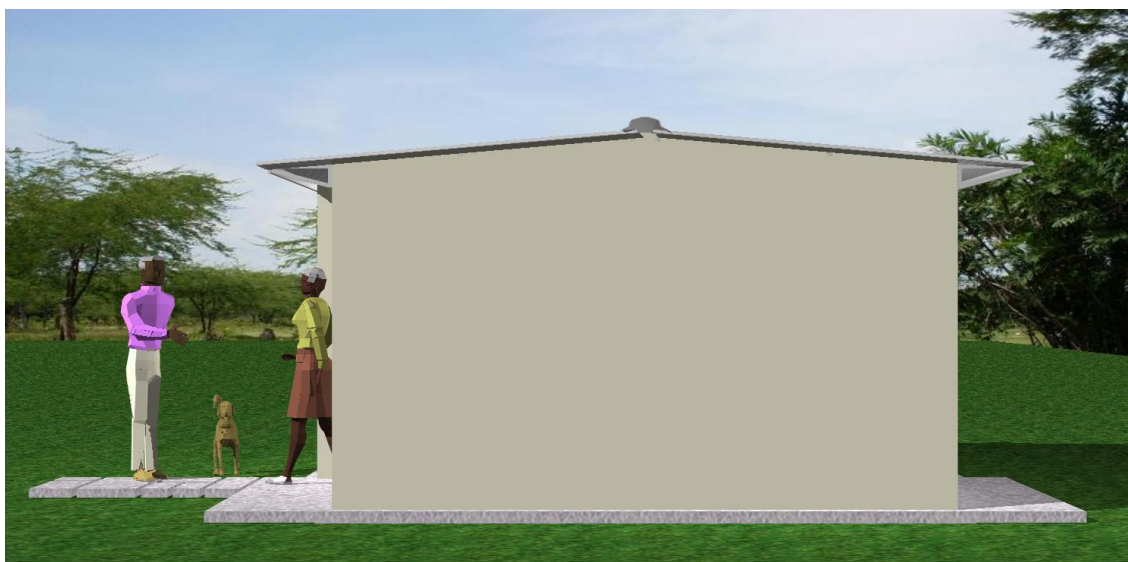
Fachada lateral de vivienda emergente sistema "L panel"
